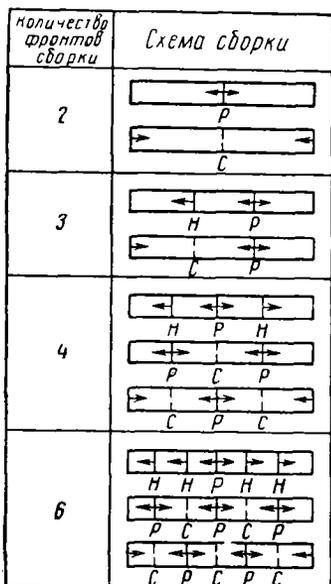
Схема сборки металлических плит на покрытии ВПП;
